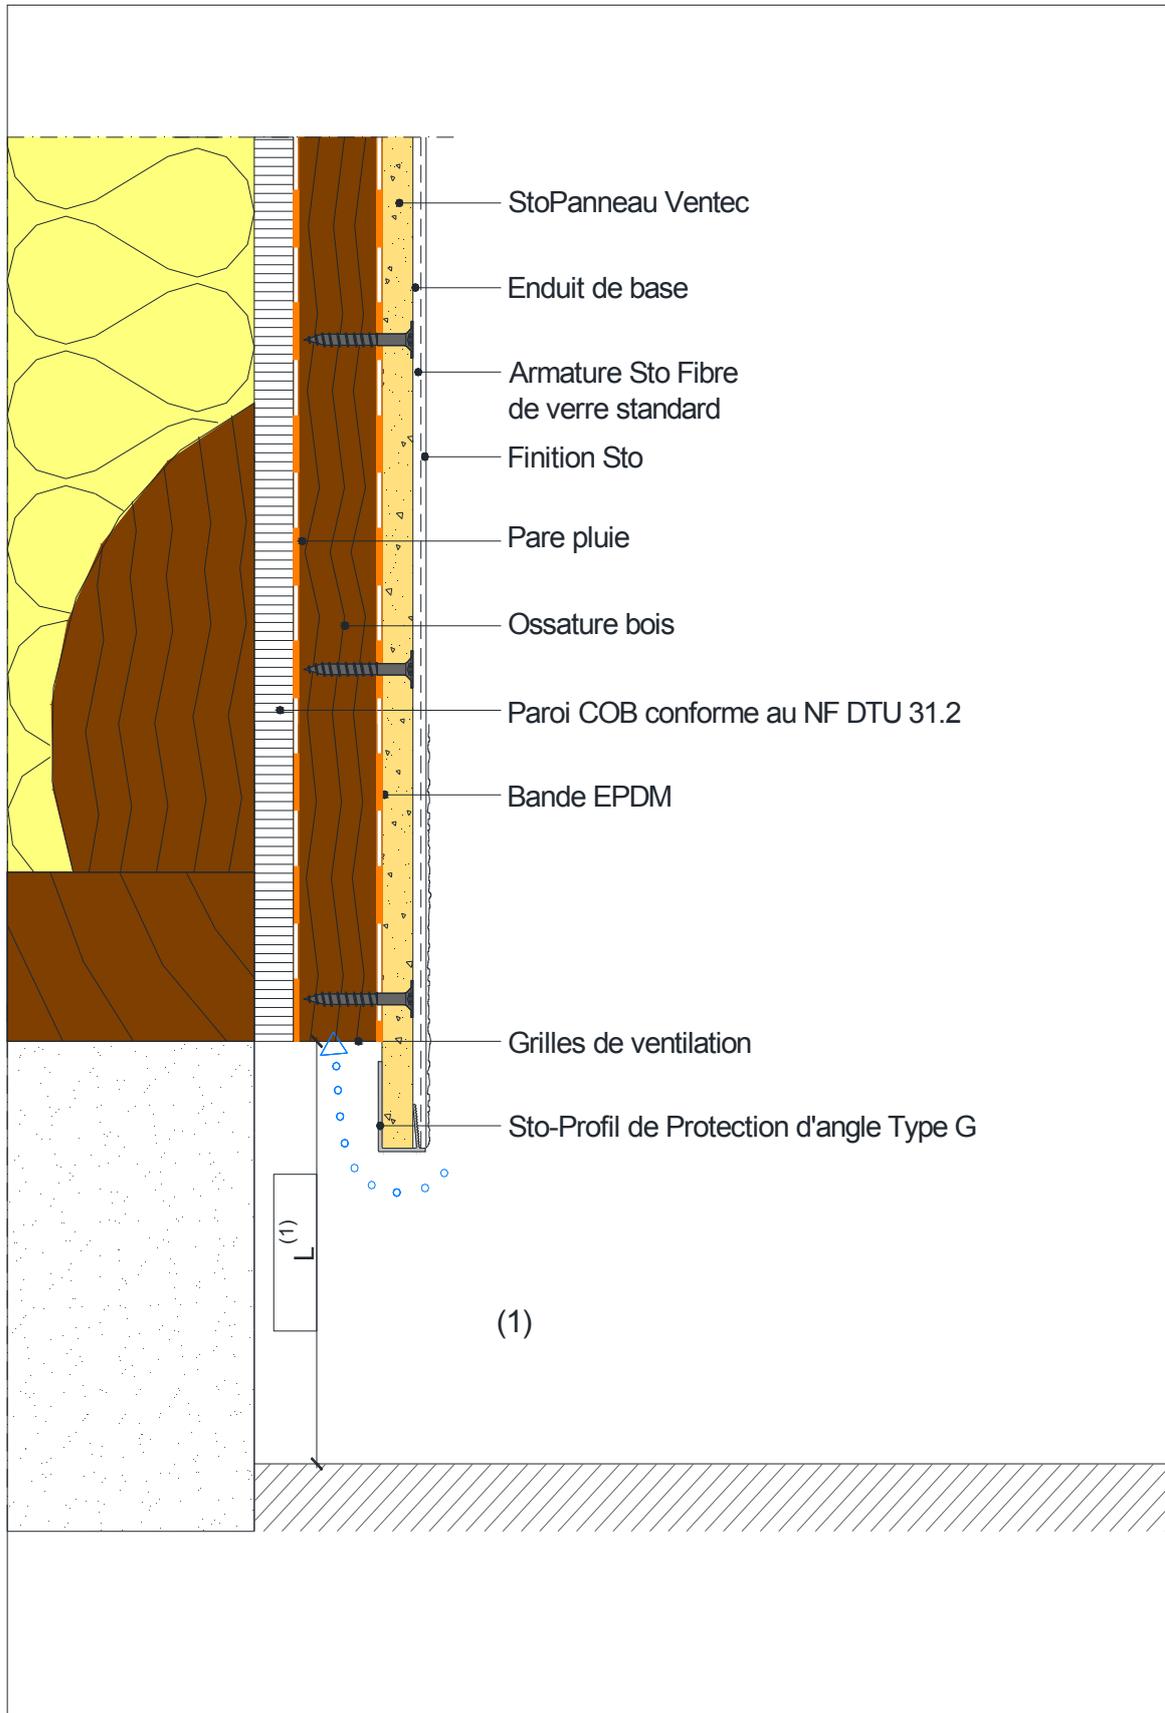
Coupe verticale - Pied de bardage - Ossatures bois sur COB
